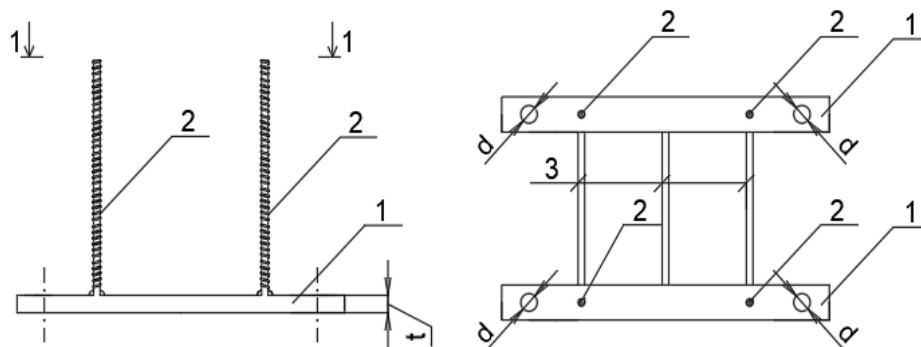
Закладная деталь: 1 – стальная пластина; 2 – арматурные стержни периодического профиля; 3 – соединяющие арматурные стержни периодического профиля (иллюстрация авторов)
